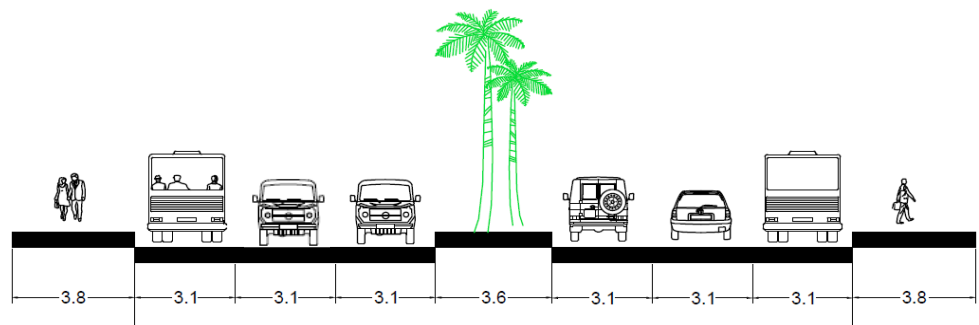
Tramo Norte Av. Abraham Calzacon.
